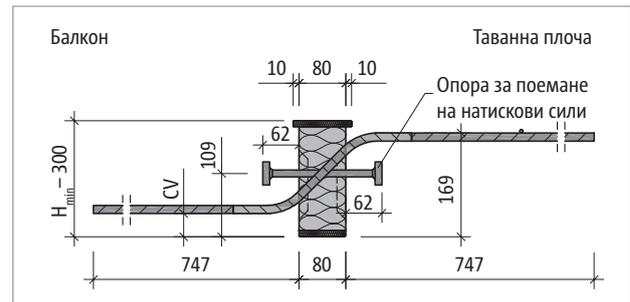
Schöck Isokorb® T тип QP-V5: Сечение на продукта
